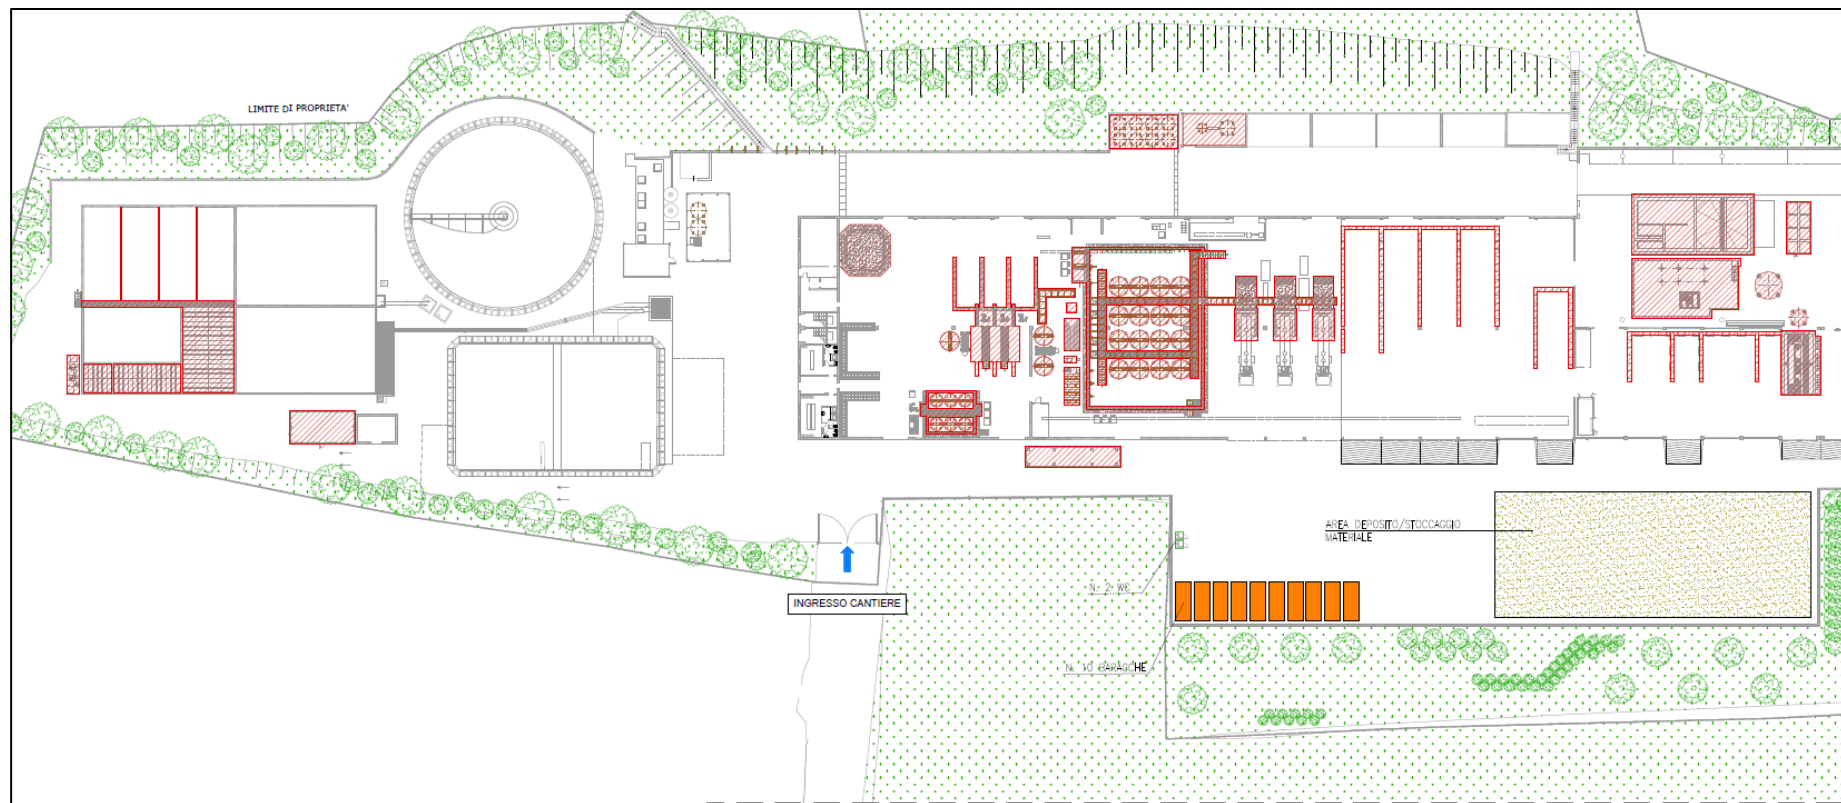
Planimetria area di cantiere durante la fase di cantiere numero 3 (Realizzazione delle opere civili di preparazione del sito) [Fonte: stralcio elaborato PD A.3]
